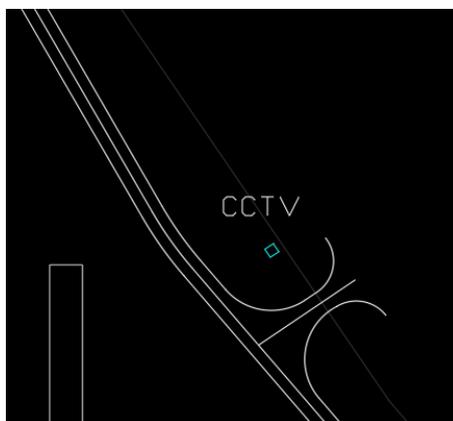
Levantamiento para as-built de las cámaras de seguridad CCTV
